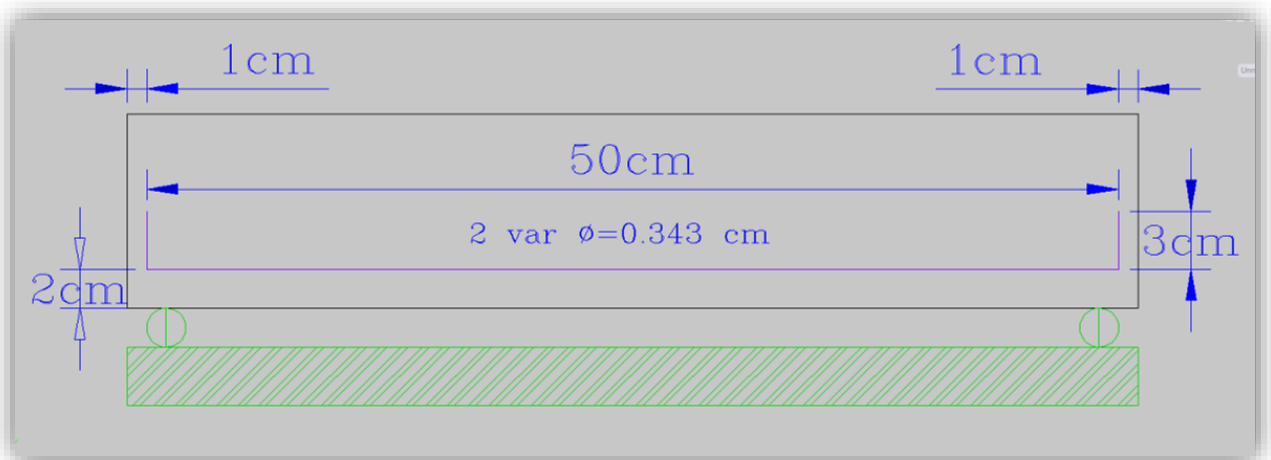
Configuración longitudinal de la viga reforzada con acero
